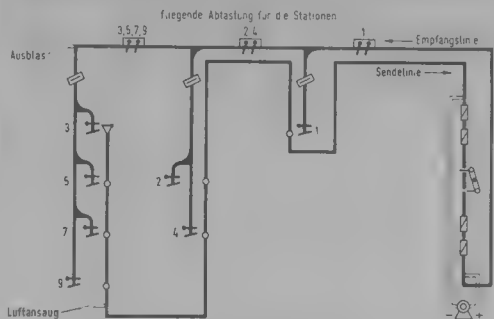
Rohrplan einer automatischen Weichenanlage mit einer fliegenden Abtastung für die Stationen.
